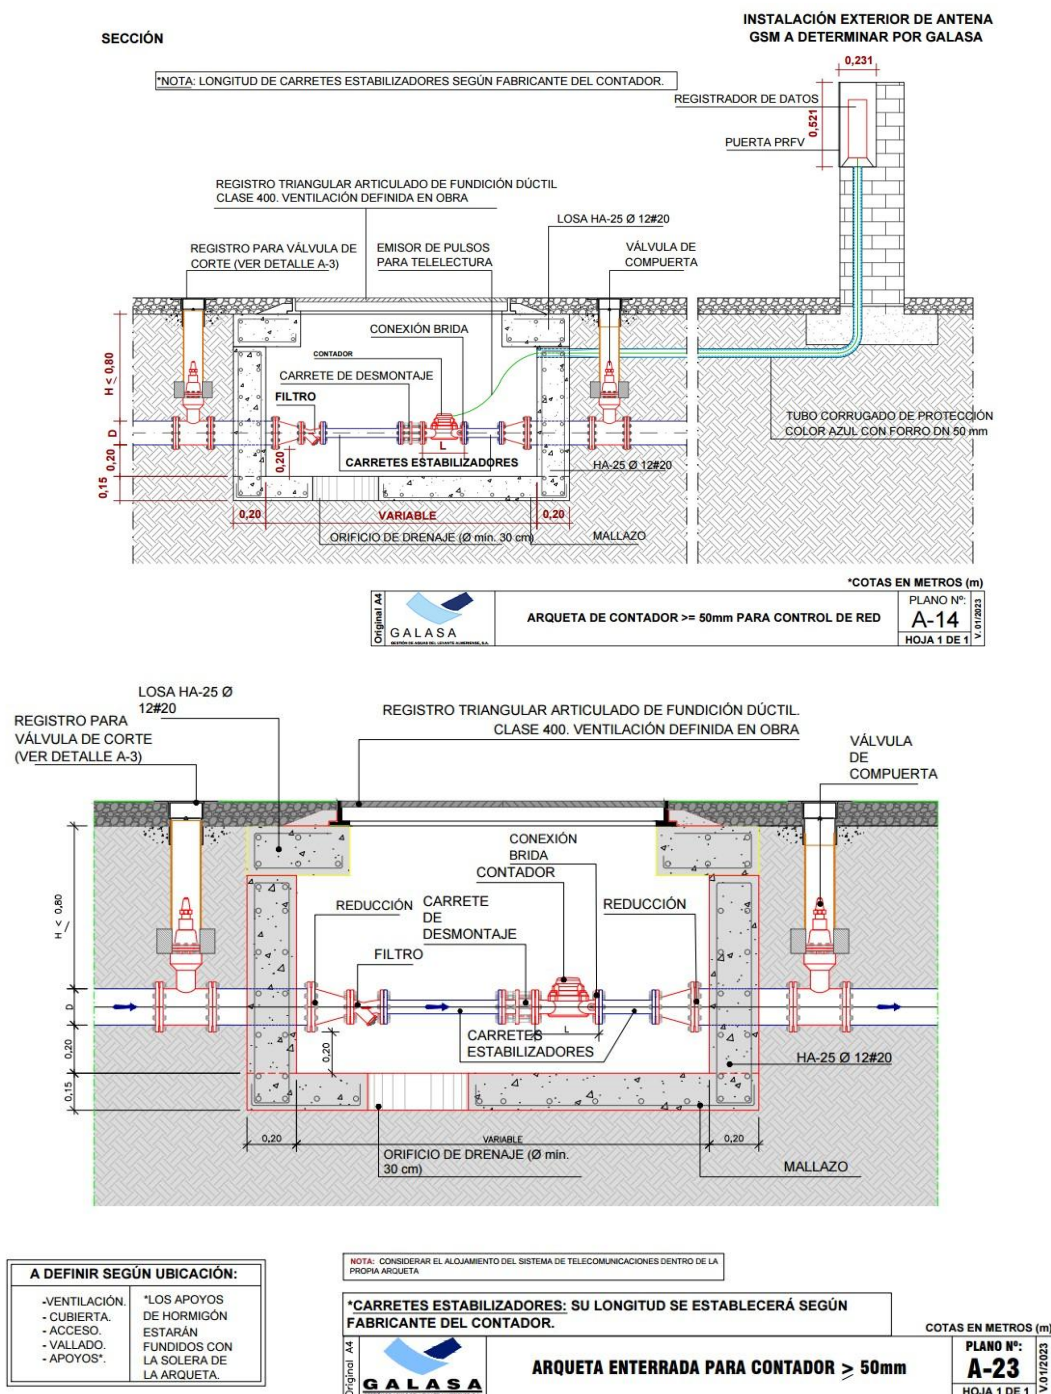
Detalle Constructivo. Instalación de contadores de red, con armario a determinar. Fuente: Galasa
